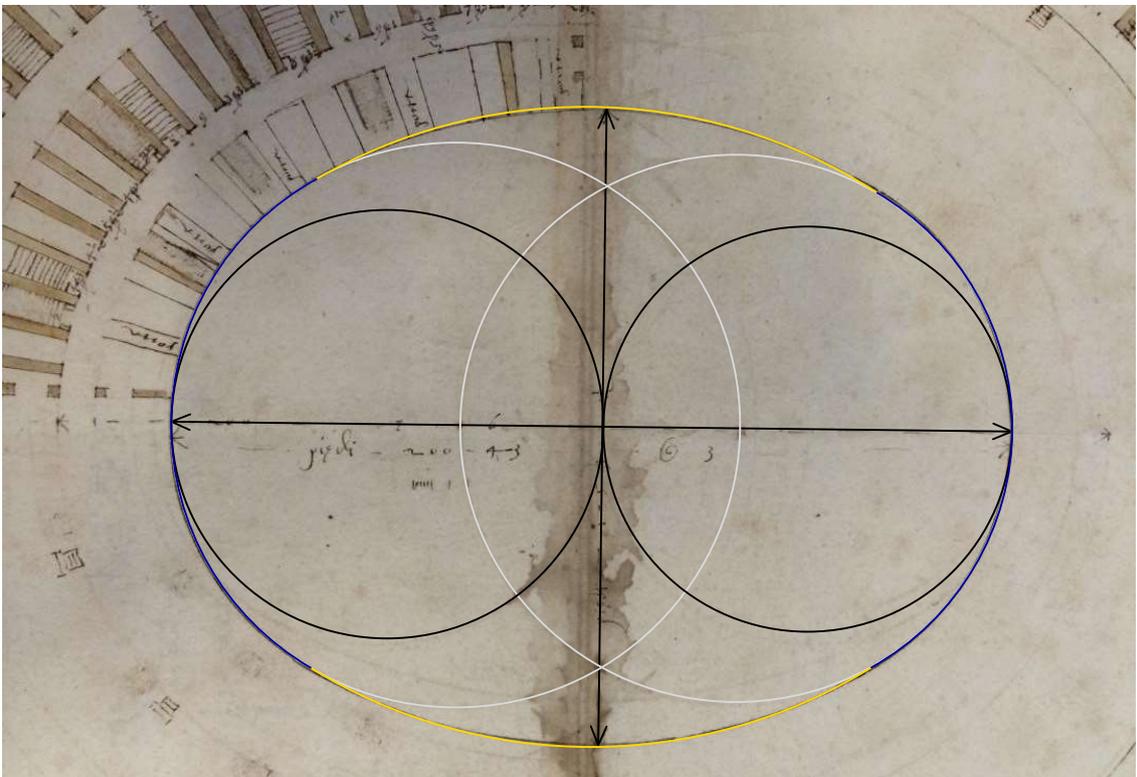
Nachzeichnung von Palladios Konstruktionsweise des Kolosseums im Detailausschnitt⁶⁸
